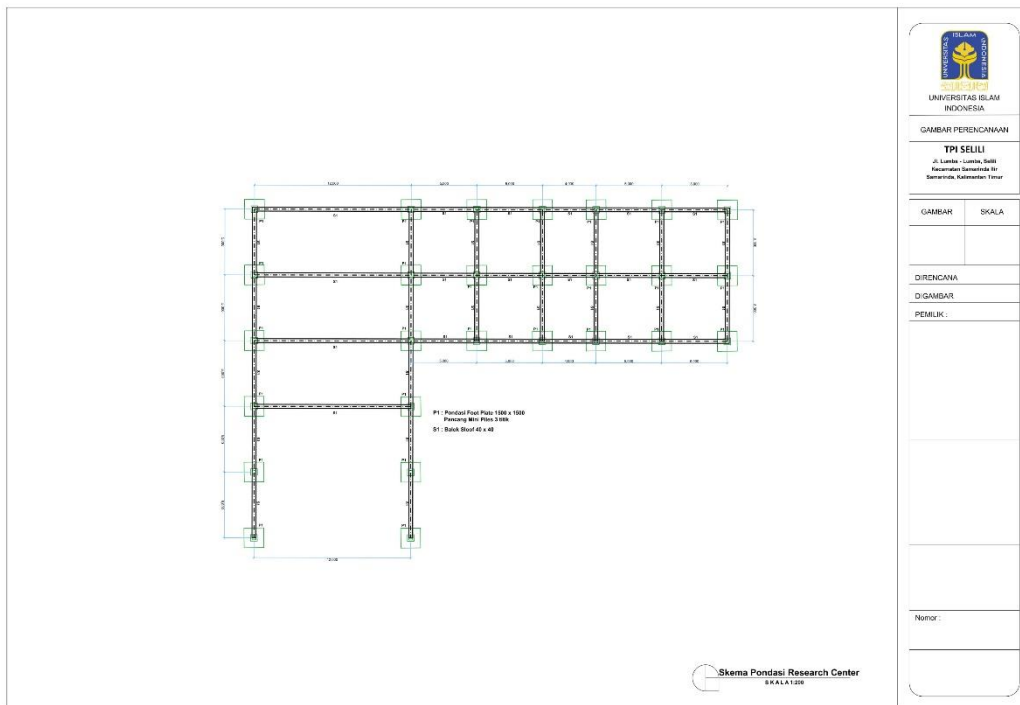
Skema Balok Lantai Dasar Research Center)
